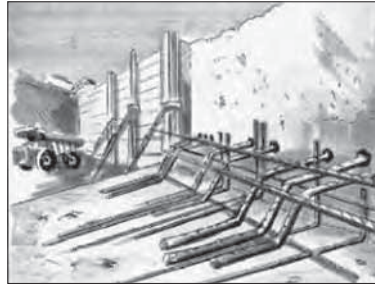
| Renowacja i naprawy konstrukcji żelbetowych
